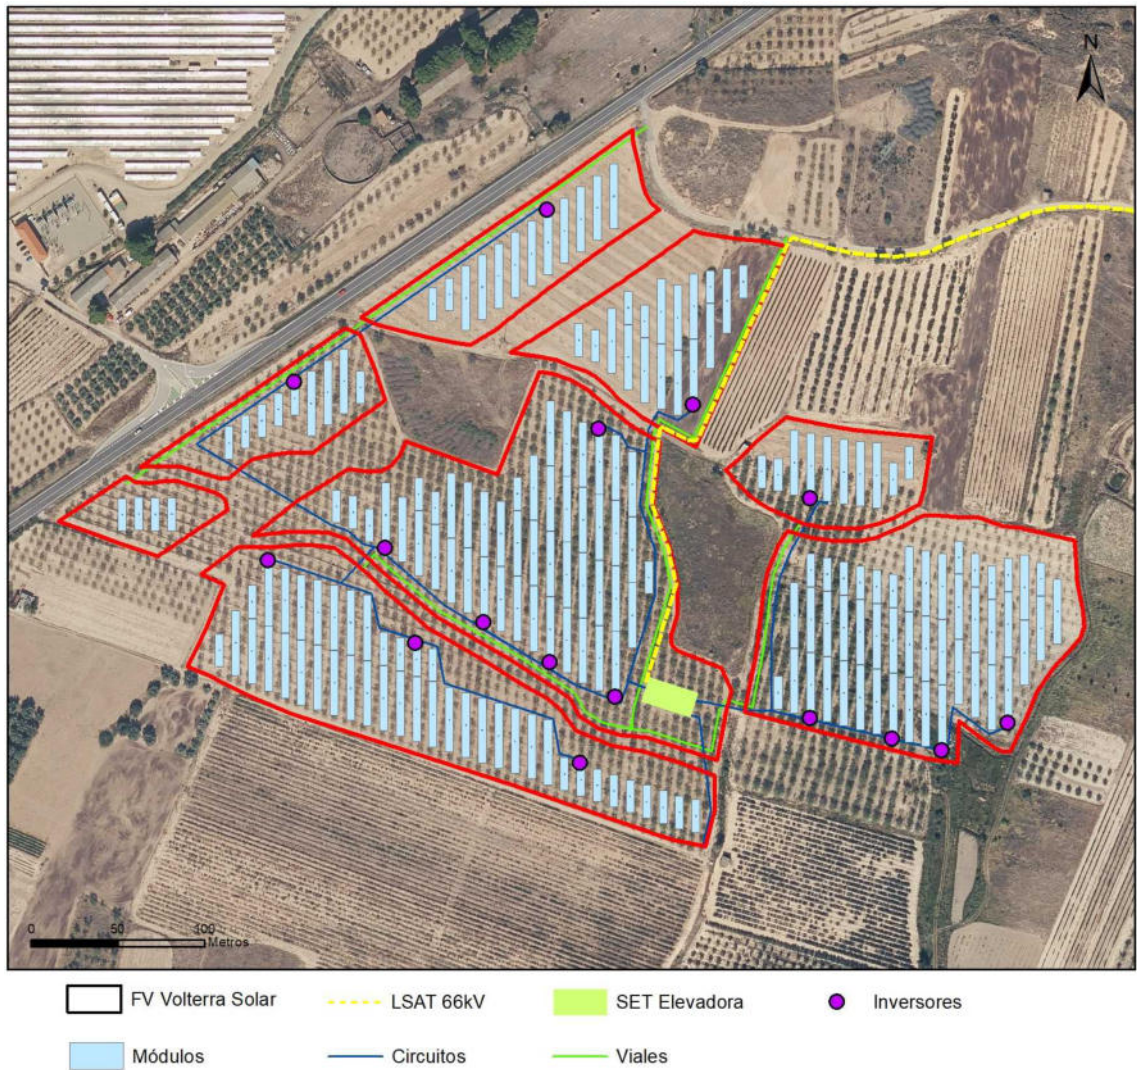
Instalaciones de la PSFV Volterra Solar. Fuente: Proyecto de ejecución de la planta solar.
